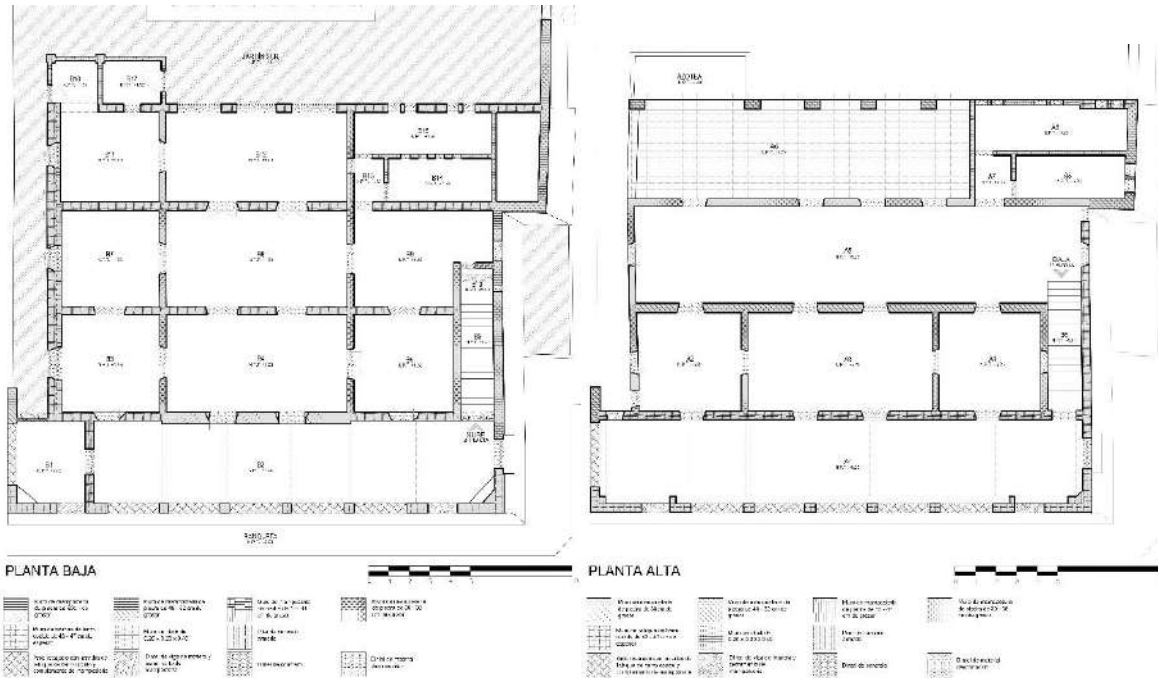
Plano de tipos de muros de planta baja y planta alta del edificio Xculucya 2017. Fuente: Elaboración propia.
